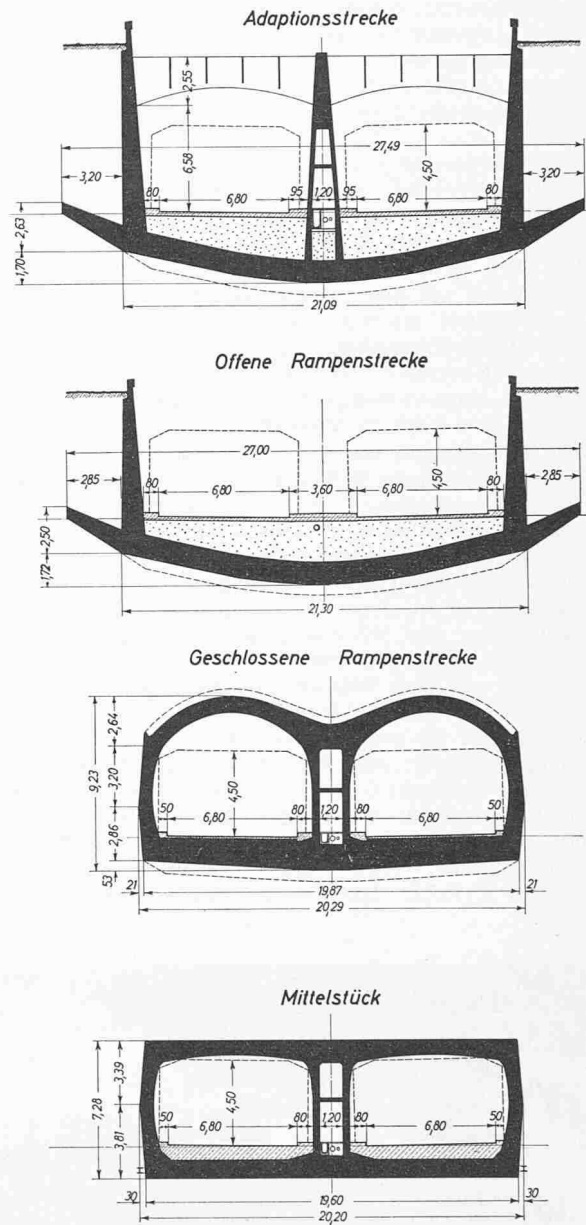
Querschnitte 1:400 durch Tunnel mit Rampen
